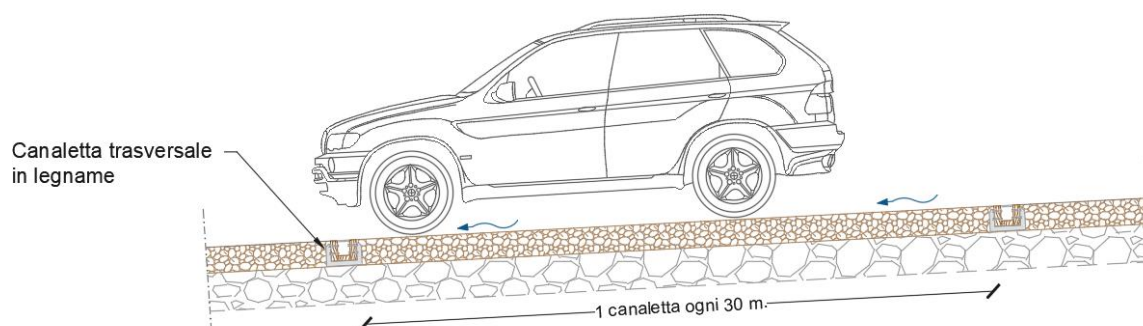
Sezione longitudinale con ubicazione delle canalette in legno.
